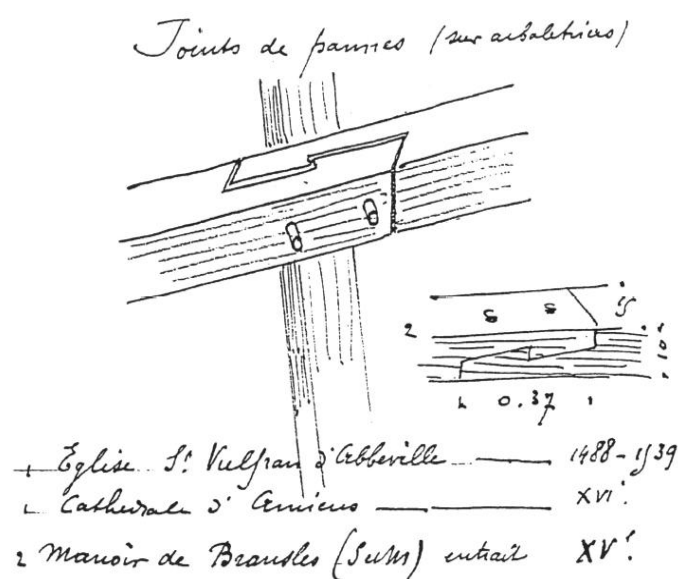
Croquis d'un assemblage à trait de Jupiter. (Dessin H. Deneux Doc. C.R.M.H.)
